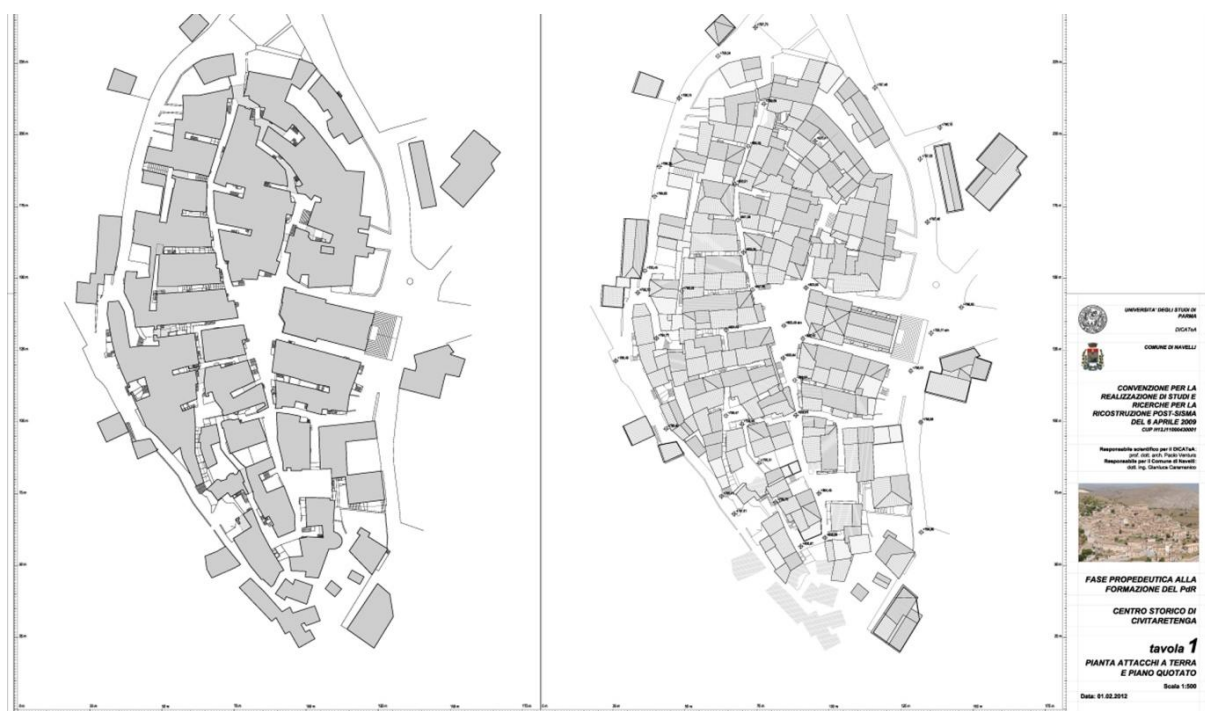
Civitaretenga - Pianta attacchi a terra e piano quotato con pianta coperture
